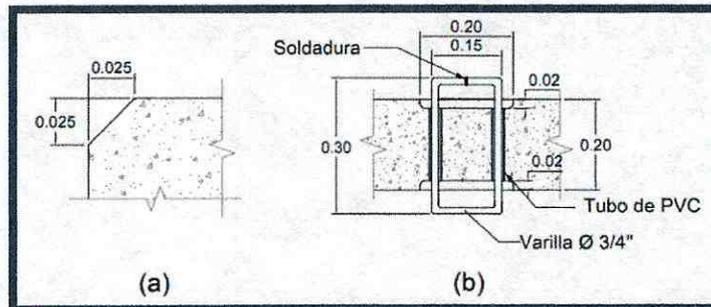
Detalles constructivos de placa superior del pozo de inspección
